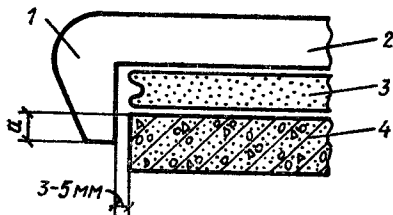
Схема испытания конструкции сжатым воздухом
